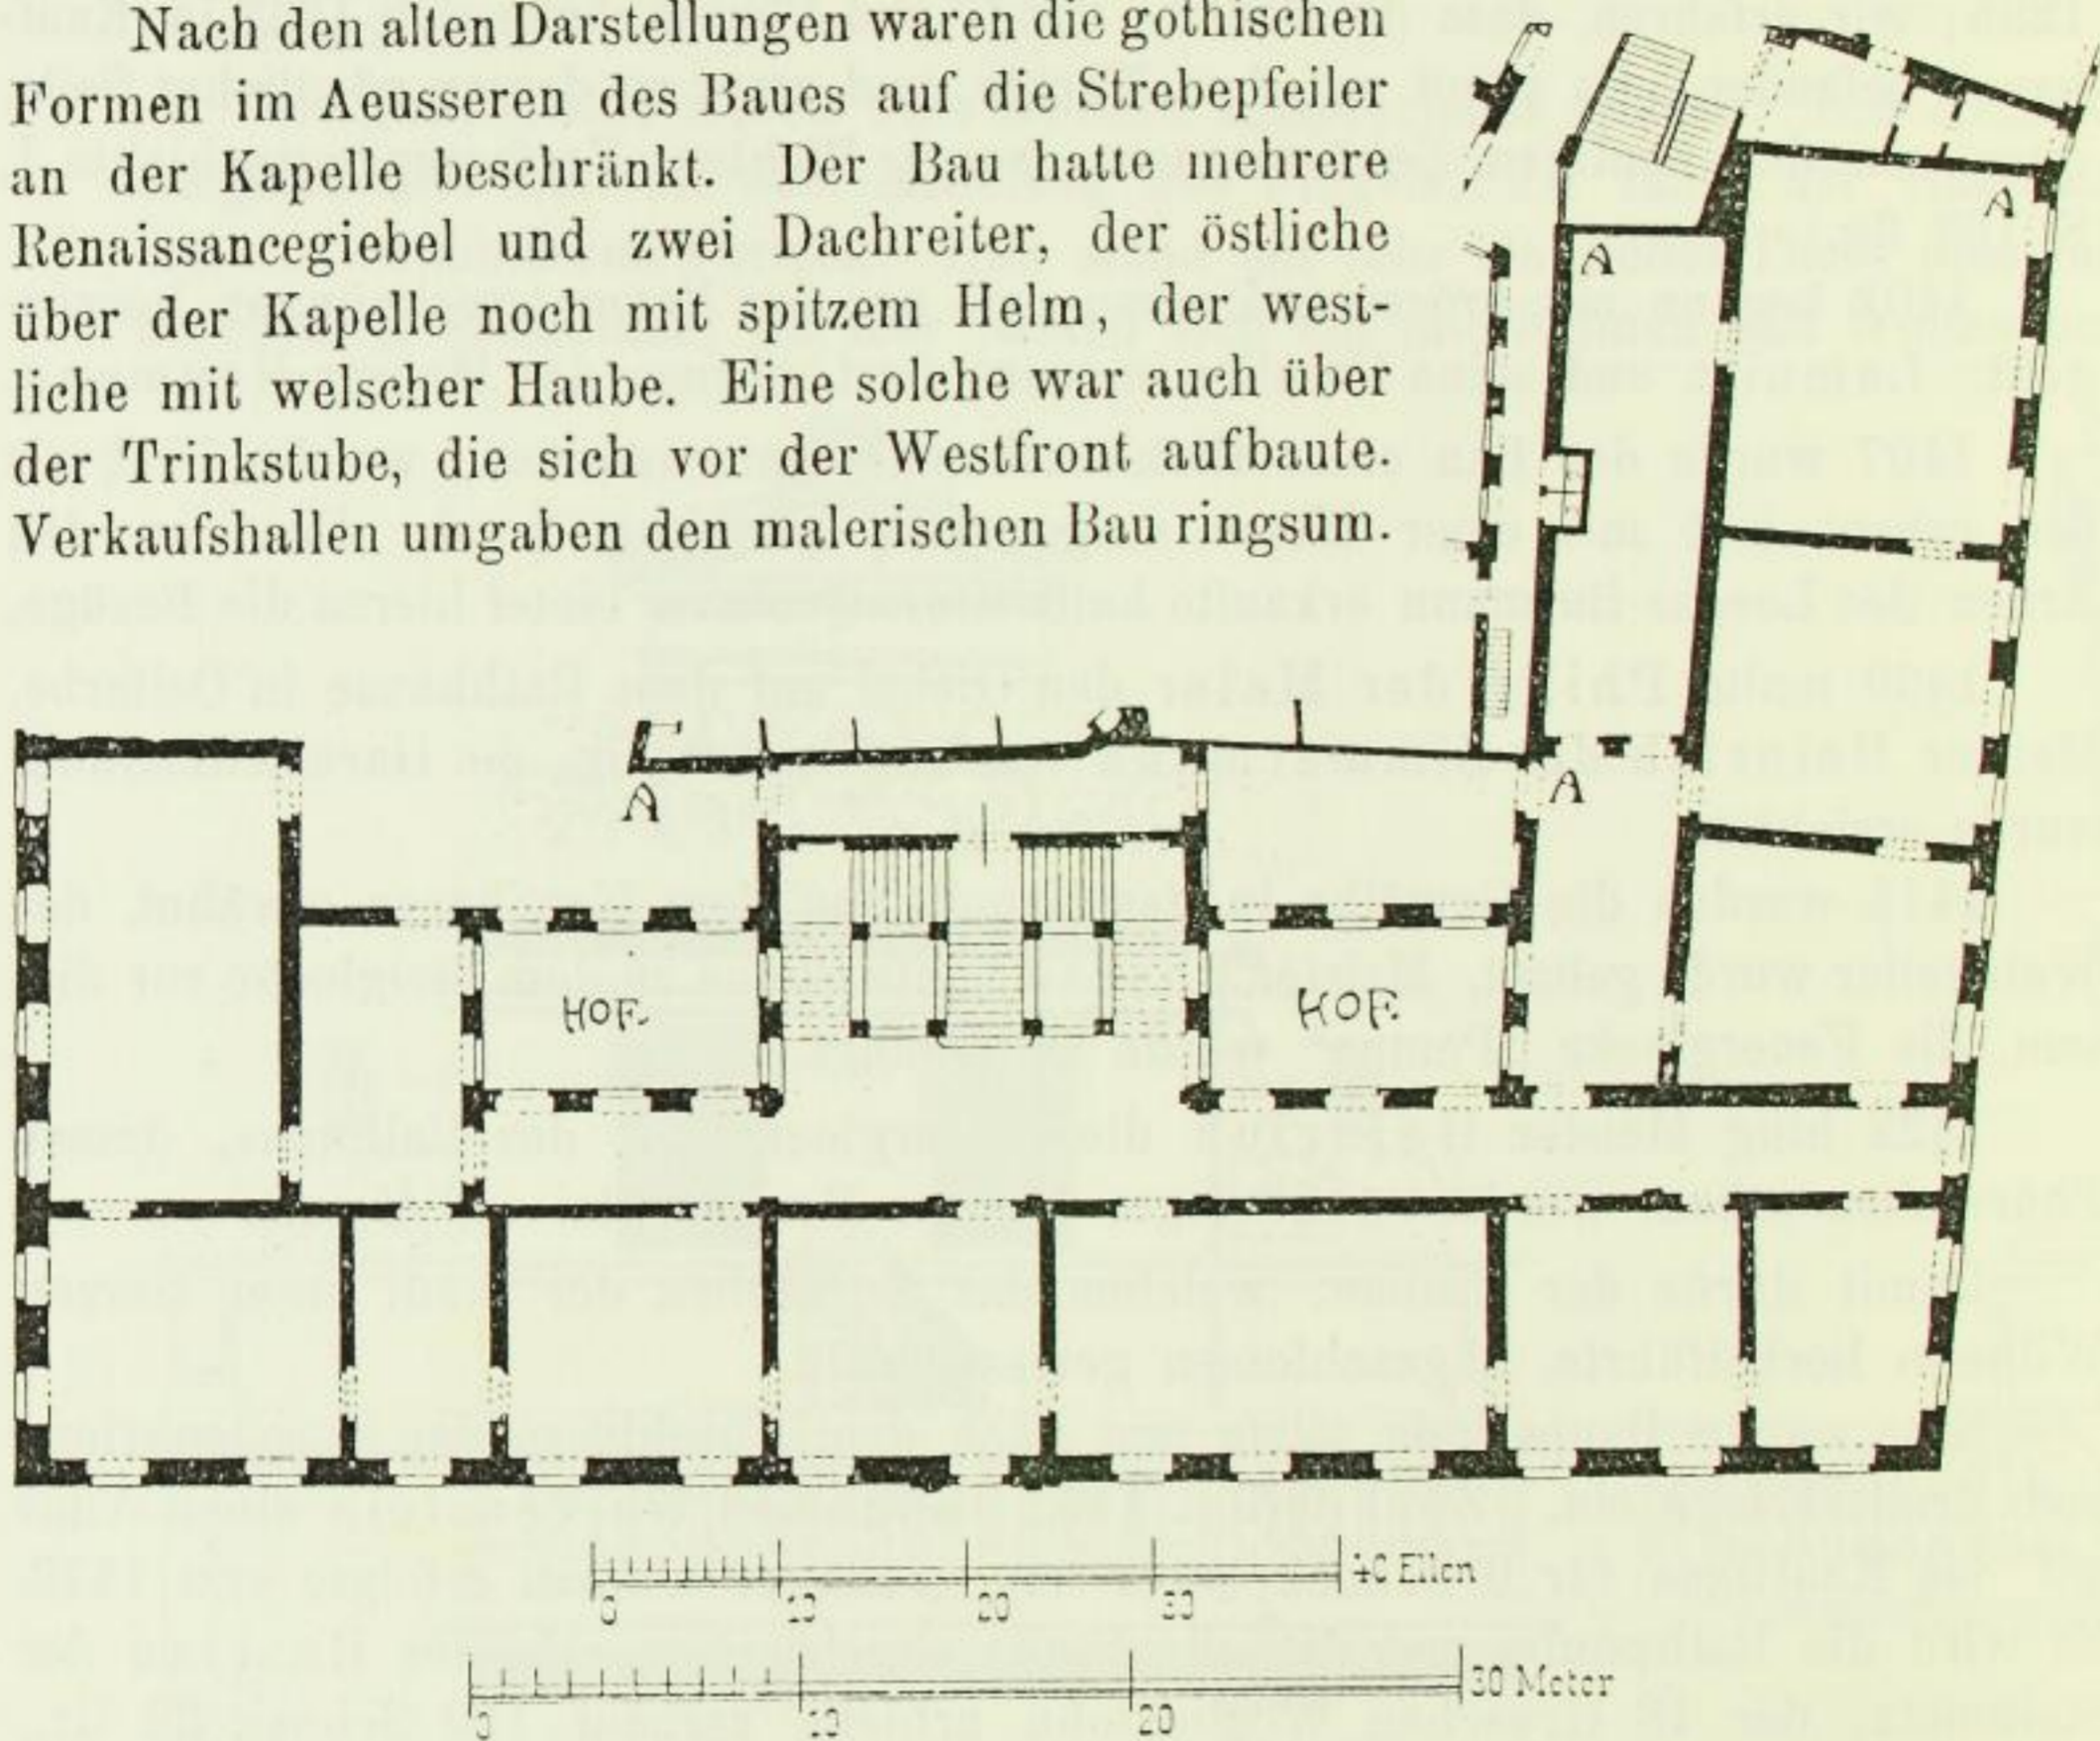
Das ältere Gewandhaus; Grundriss des Obergeschosses.
